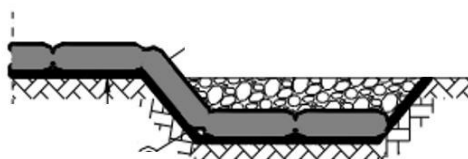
Ejemplo de la protección exterior de la colchoneta
